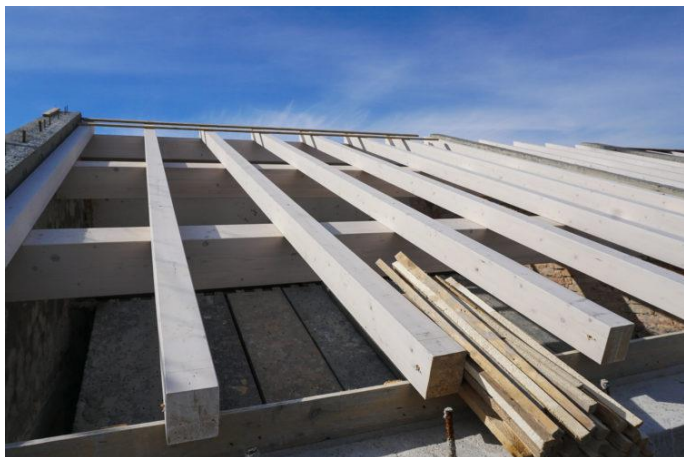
Rifacimento della copertura con struttura leggera in legno.
